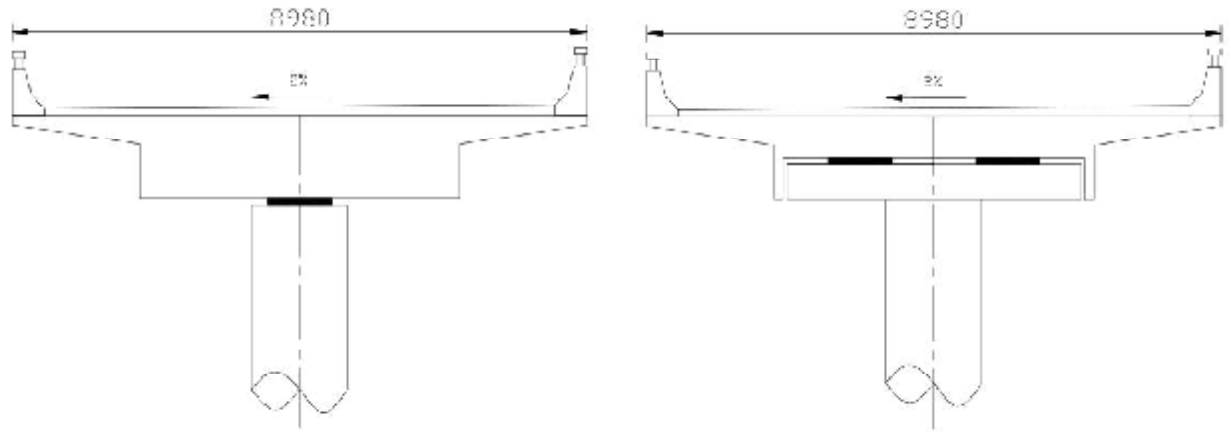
辅道桥梁端截面示意图 (单位: mm)
